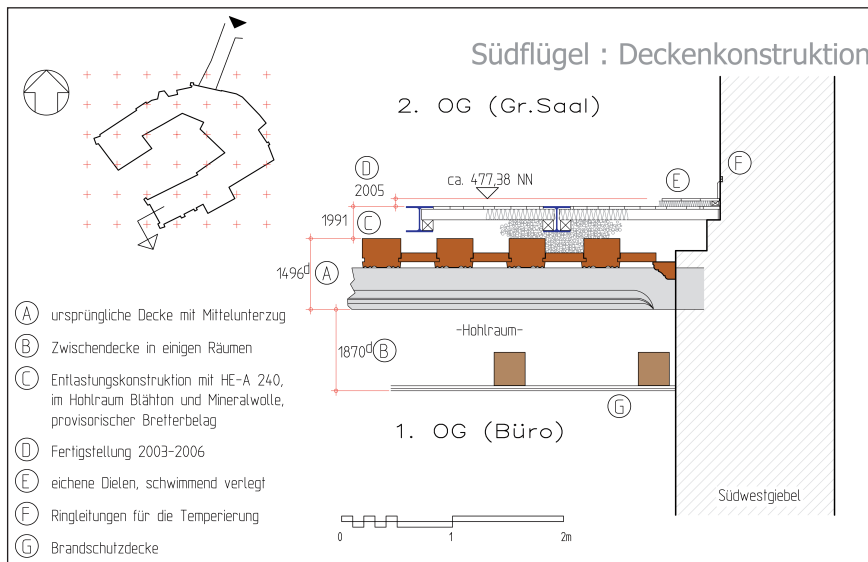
Detailzeichnung: Deckenaufbau im Südflügel, Decke über dem ersten Obergeschoss.
